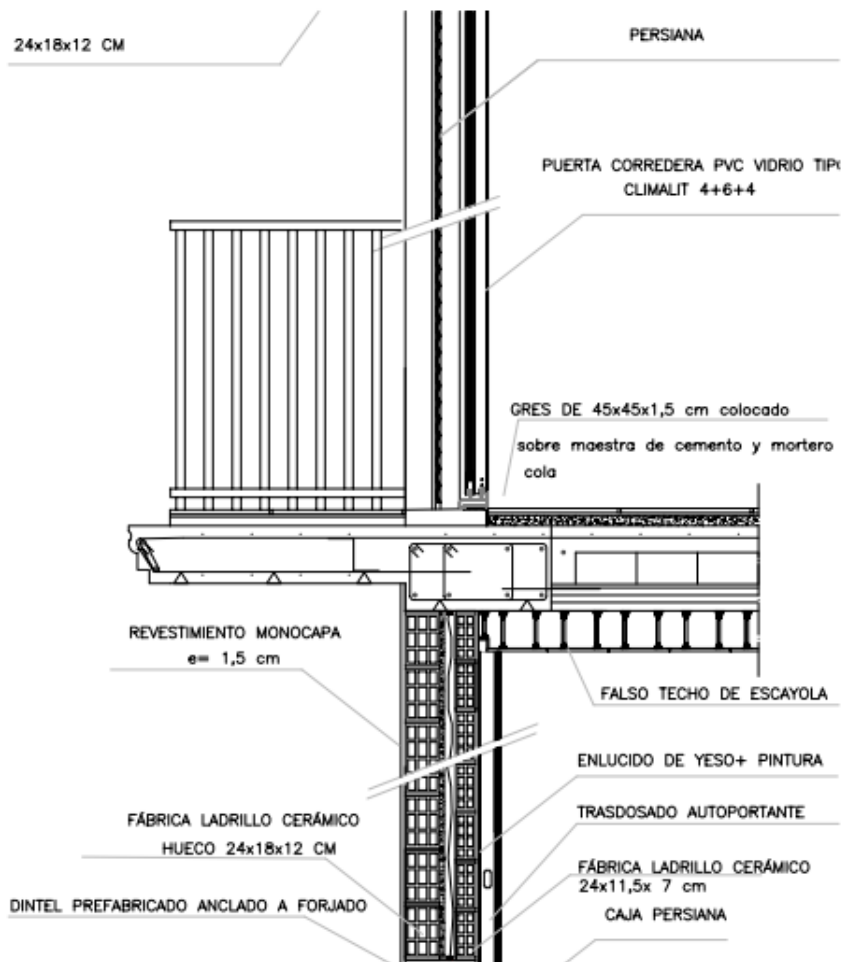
Detalle encuentro balcón sistema trasdosado. Año 2015. Fuente propia.
